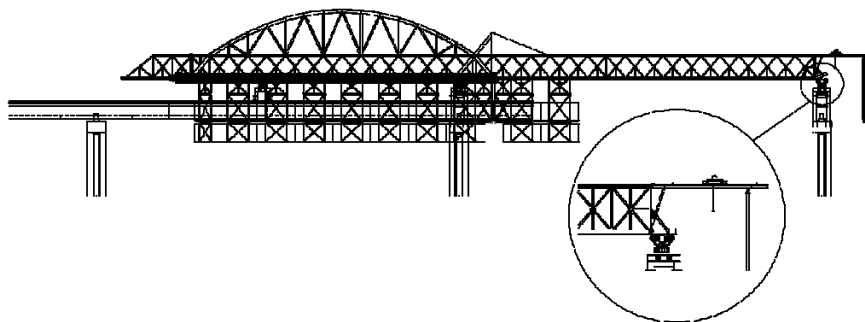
Elevação do nariz para apoio no segundo pórtico de pilar
